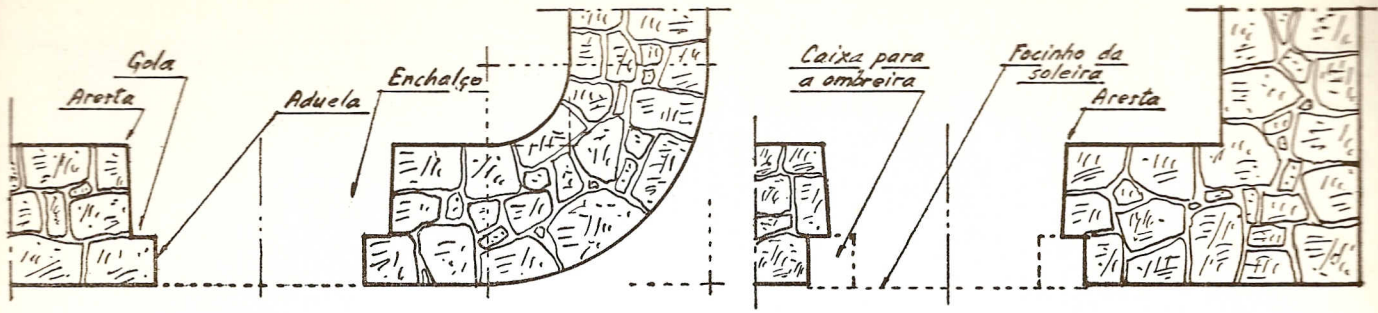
PAREDES DE ALVENARIA DE PEDRA
